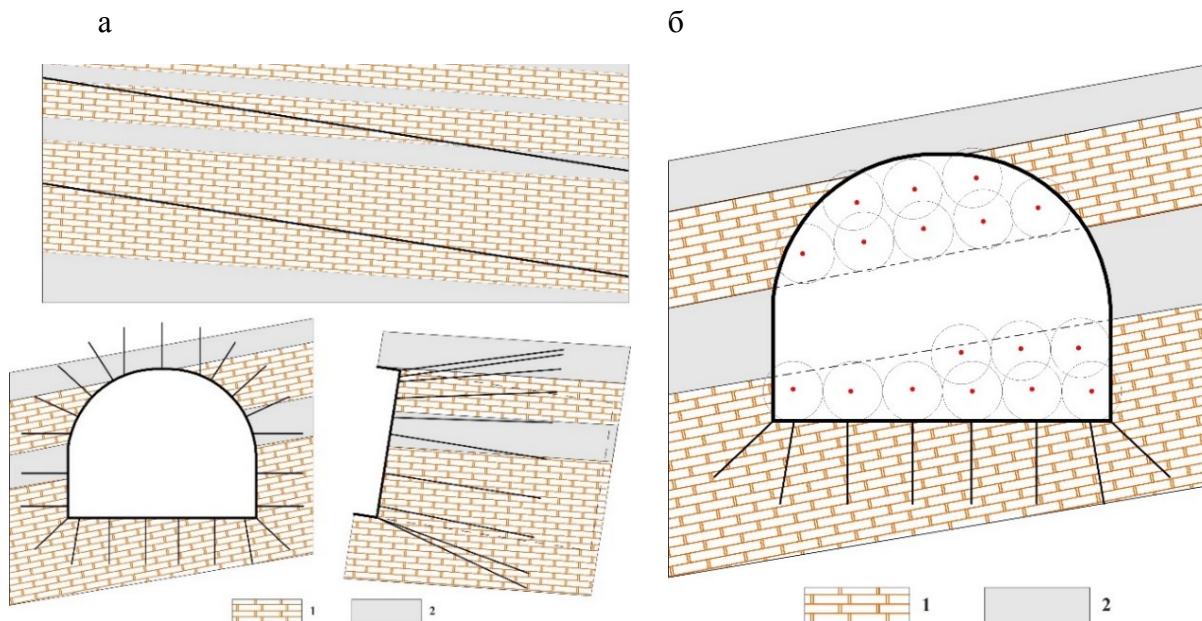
Режим пересечения подготовительными выработками при механизированном (комбайновом) способе проходки слоев пород при расположении выбросоопасных пород в почве, проектном сечении выработки и кровле (1 фаза –а, 2 фаза –б): 1 – выбросоопасные породы; 2 – невыбросоопасные породы
